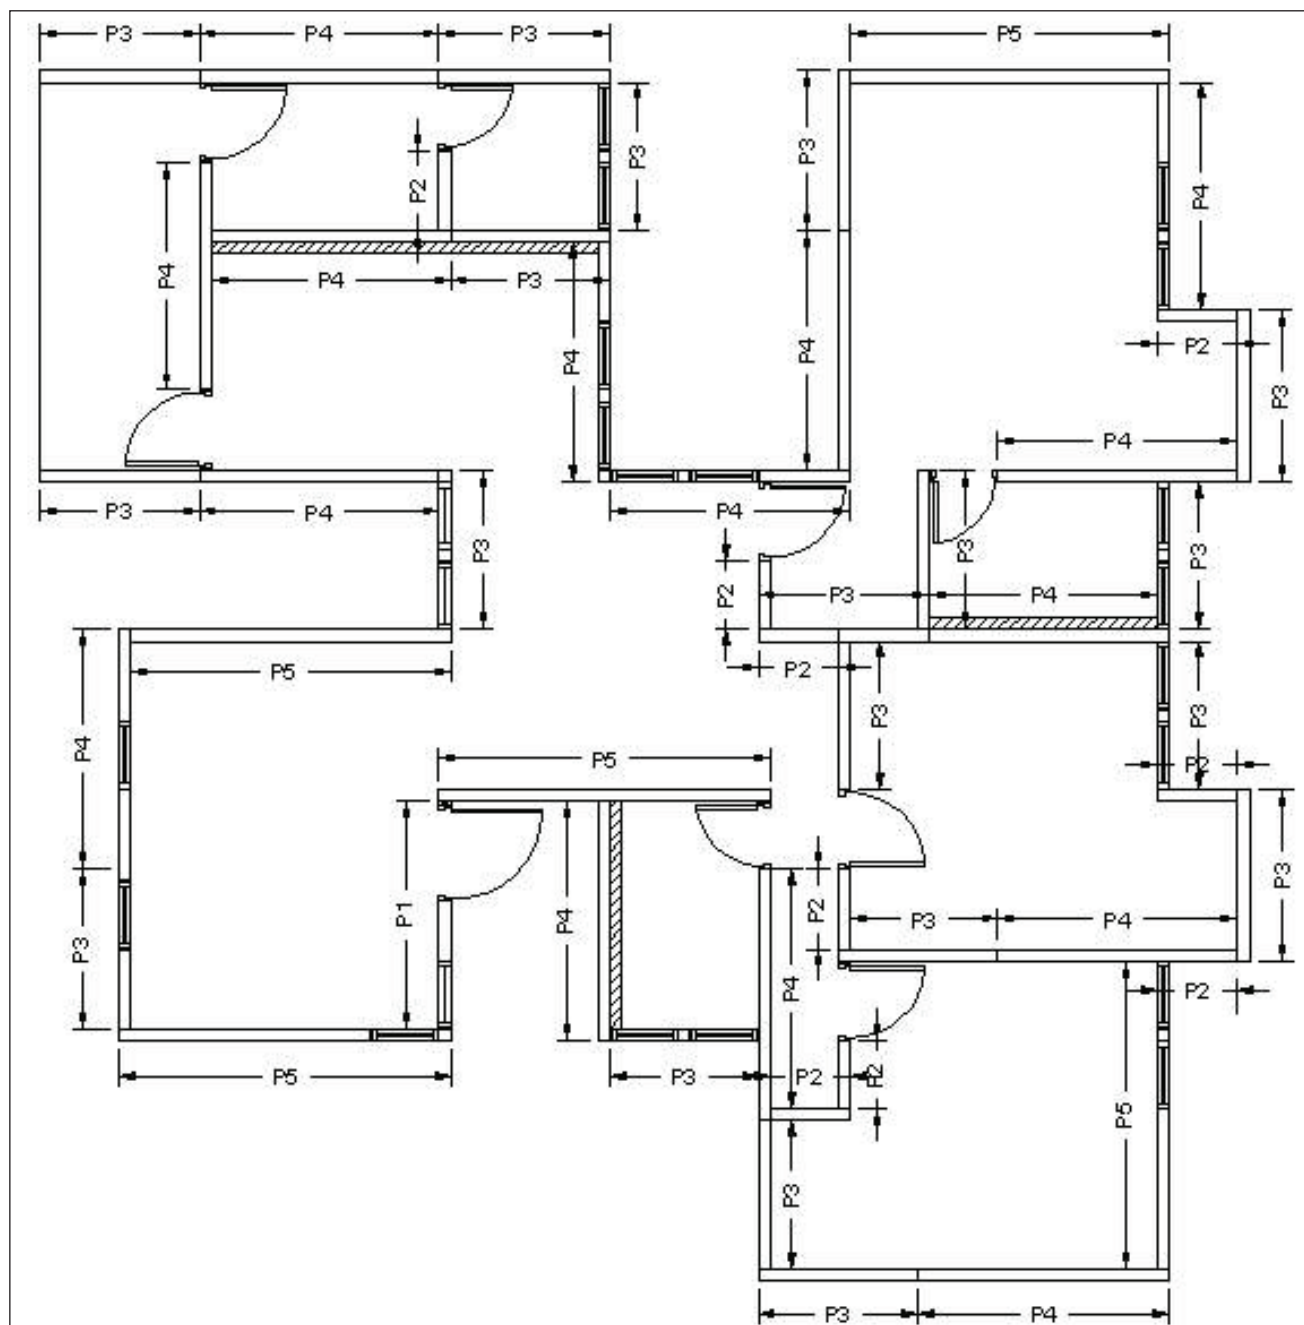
Planta rediseñada del Modelo 2, con la distribución de paneles realizados por los autores.
